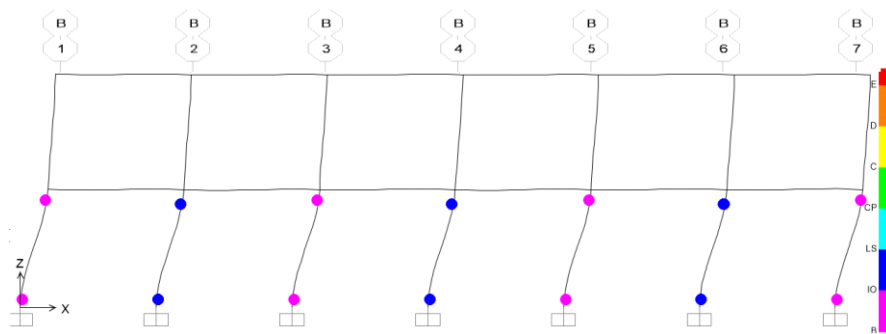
Deformada del pórtico B (ocasional). Fuente: Propia.
